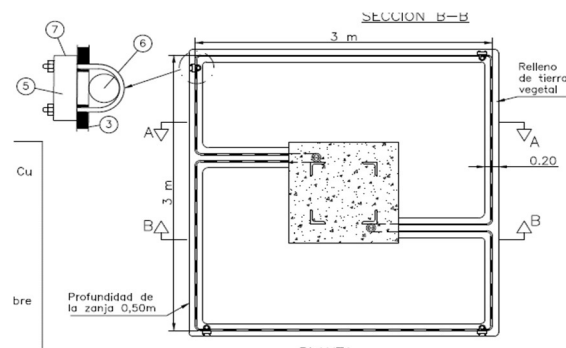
Diseño estándar de PaT de apoyo frecuentado.
